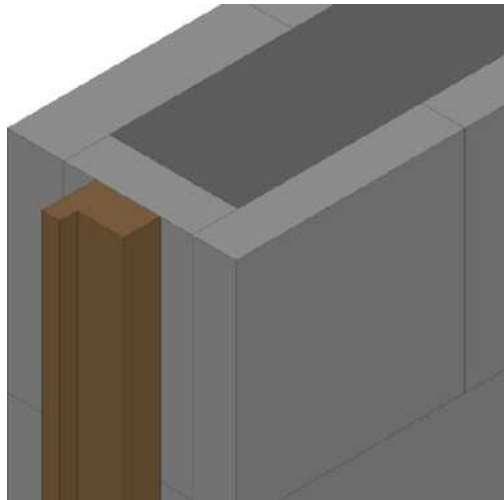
Colocação da caixilharia directamente sobre o fecho de parede (ARGISOL, 2010).
